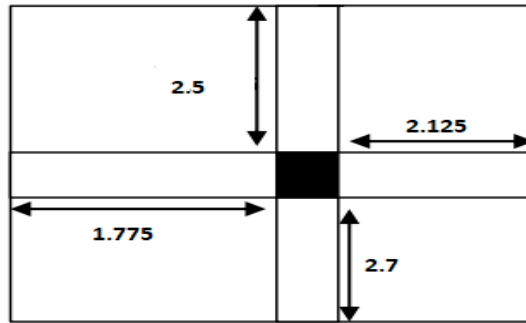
La surface afférente S1 poteau (35x40) cm²
